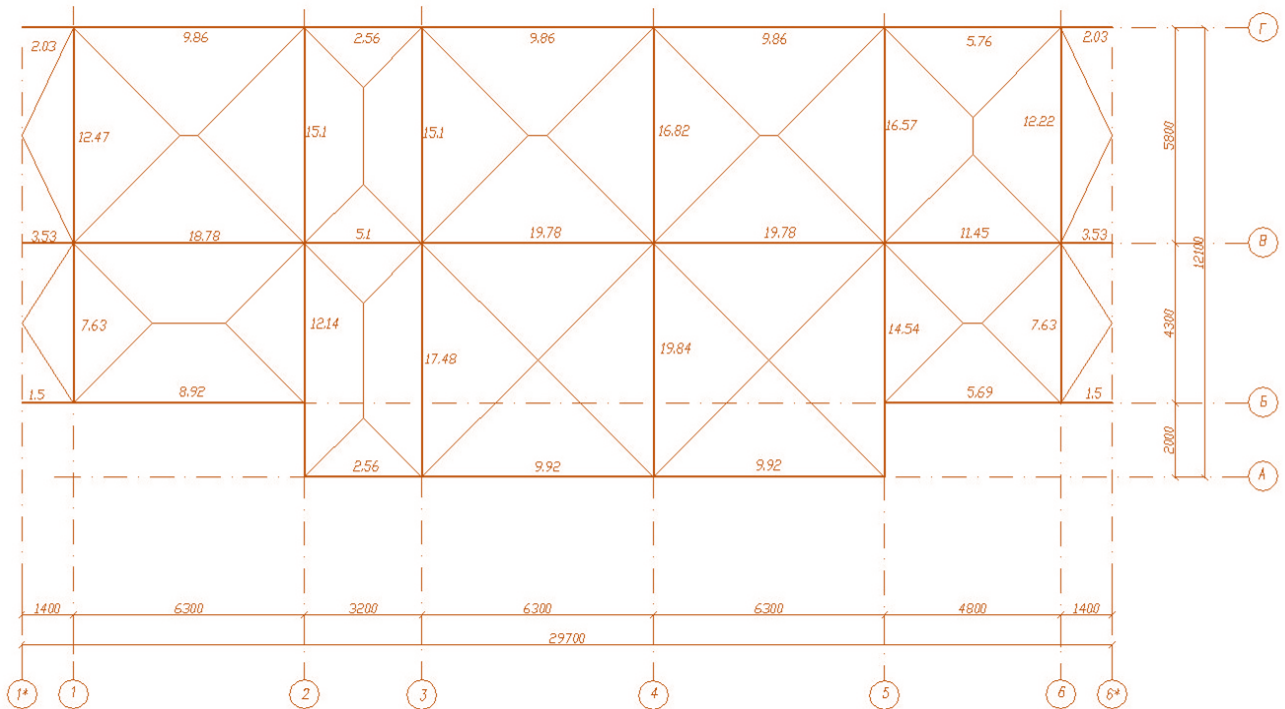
Схема вантажних площ, що передають навантаження на ригелі
